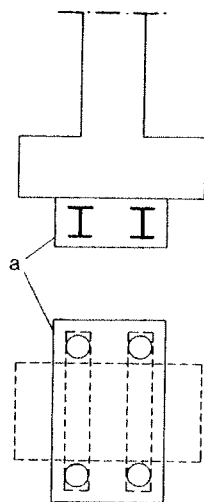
Consolidamento delle fondazioni con pali: *a*, nuovo plinto costruito per sottofondazione (sopra: sezione verticale; sotto: pianta).
